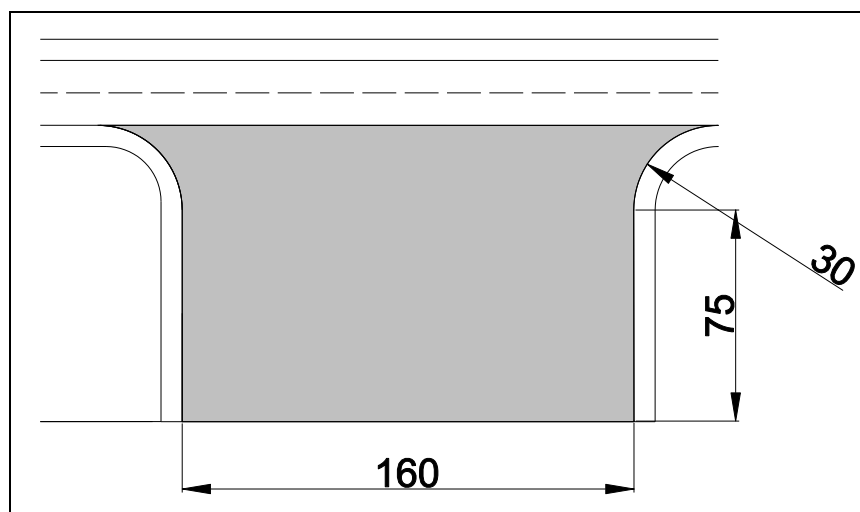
Pavimentação da pista de táxi do Ramo E
